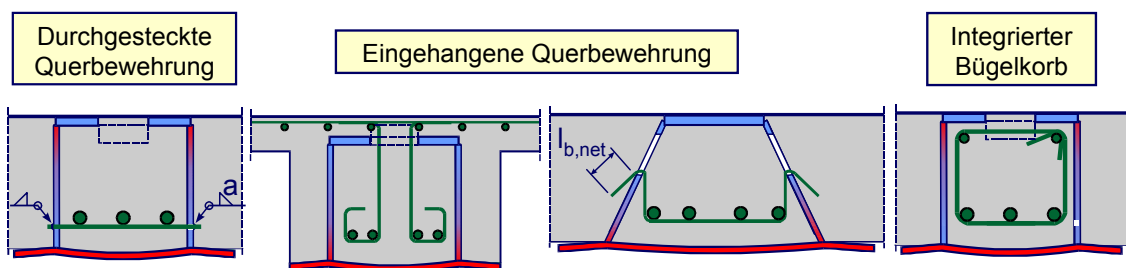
Anschluss mittels einer Bügelbewehrung
